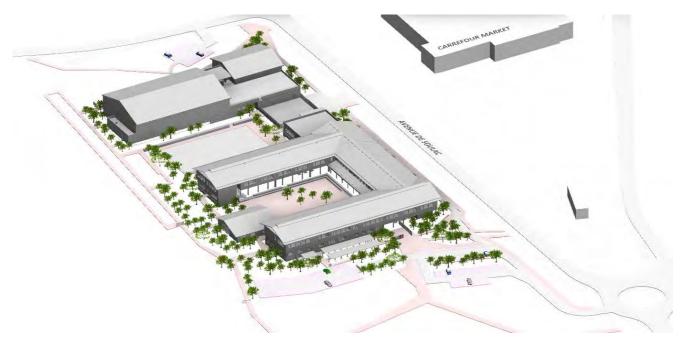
Plan 3D du collège à la fin de la phase chantier
